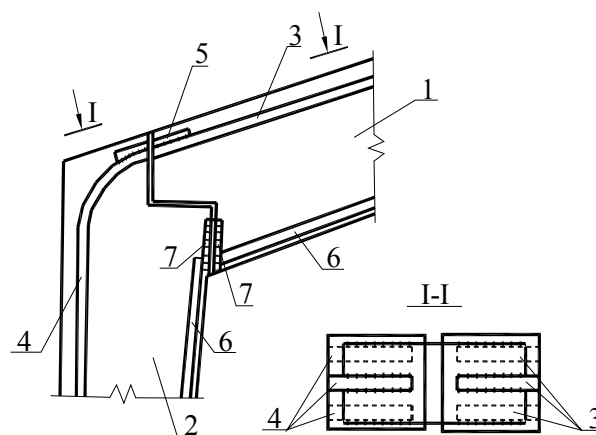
Вузол з'єднання ригеля зі стійкою піврами по а. с. №1028811:
